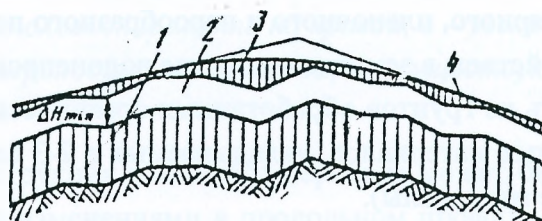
Схема выравнивания покрытия на вертикальной кривой: 1 – основание; 2 – покрытие; 3 – утолщение покрытия; 4 – продольный профиль поверхности покрытия.
